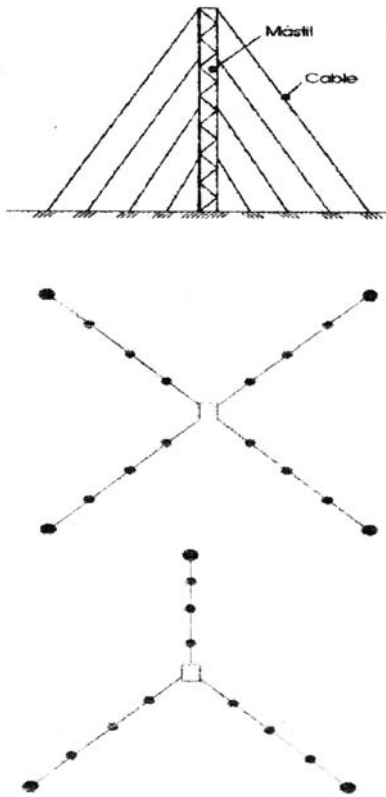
Mástil arriostrado por tres y cuatro cables [Ref. 34]
